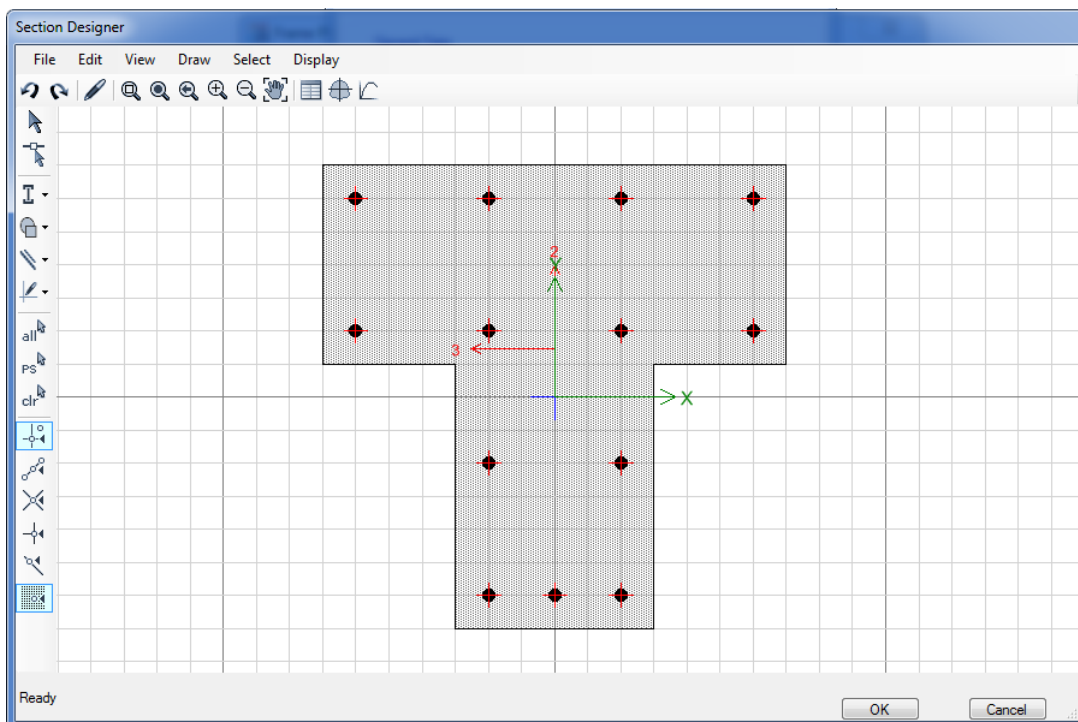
Distribución de acero de refuerzo en columna “T”, sistema convencional
